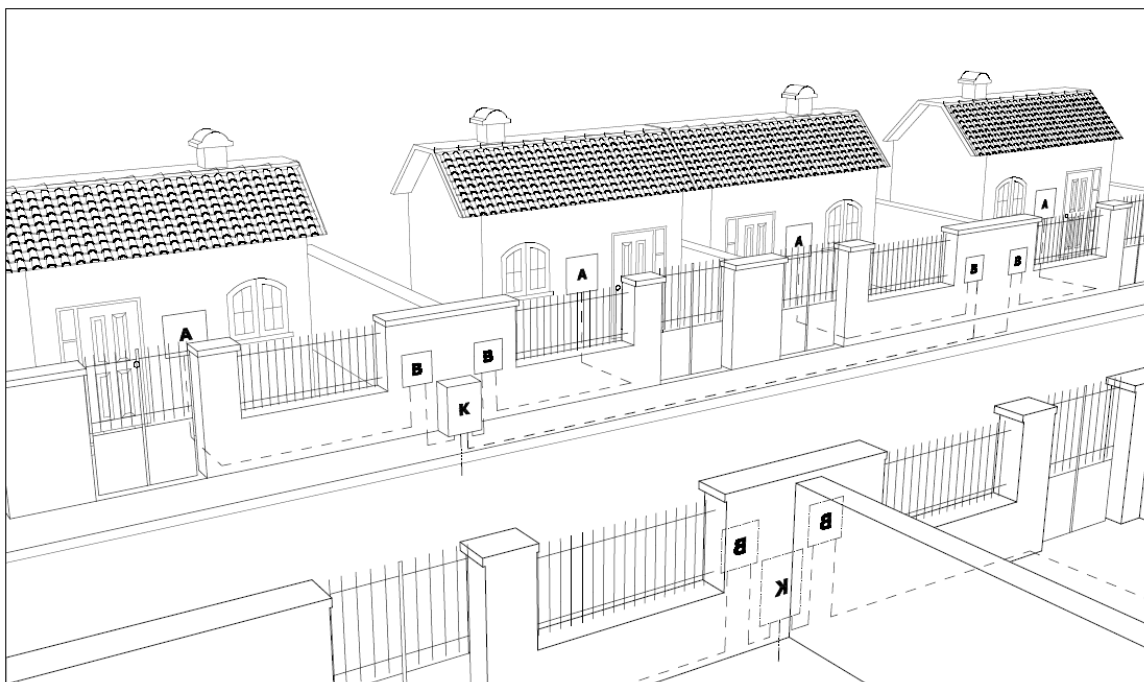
Ligação a partir de rede subterrânea – construções dotadas de muro
